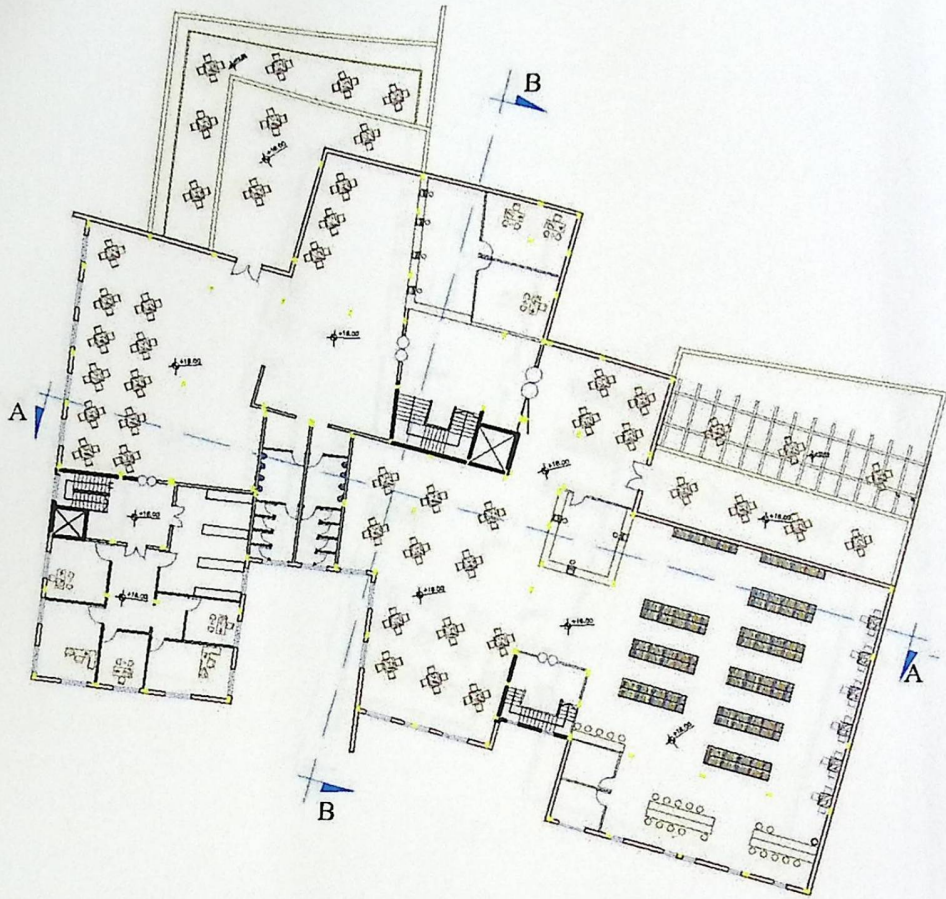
المسقط الأفقي للطابق الثاني .
